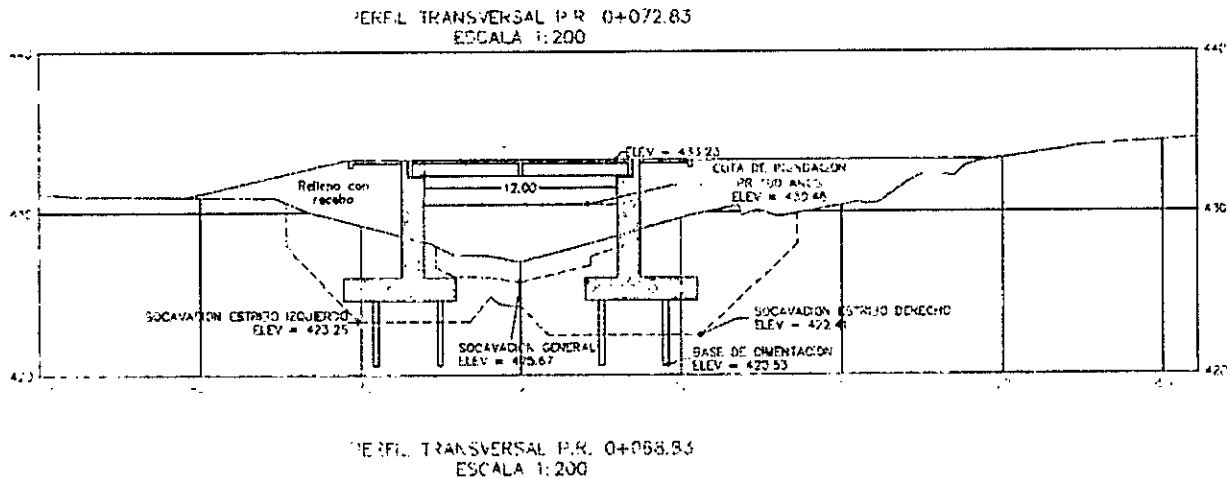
Plano Hidráulico vista en perfil transversal PR 0+u72.83 del puente. Fuente: radicado CAM No. 2025-E 33015 del 29 de diciembre del 2025.
